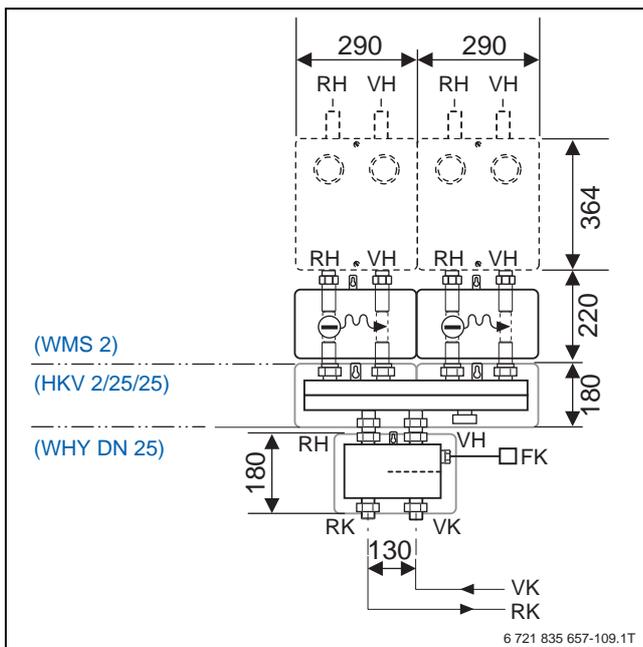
Abmessungen Wärmemengenzähler-Set mit
